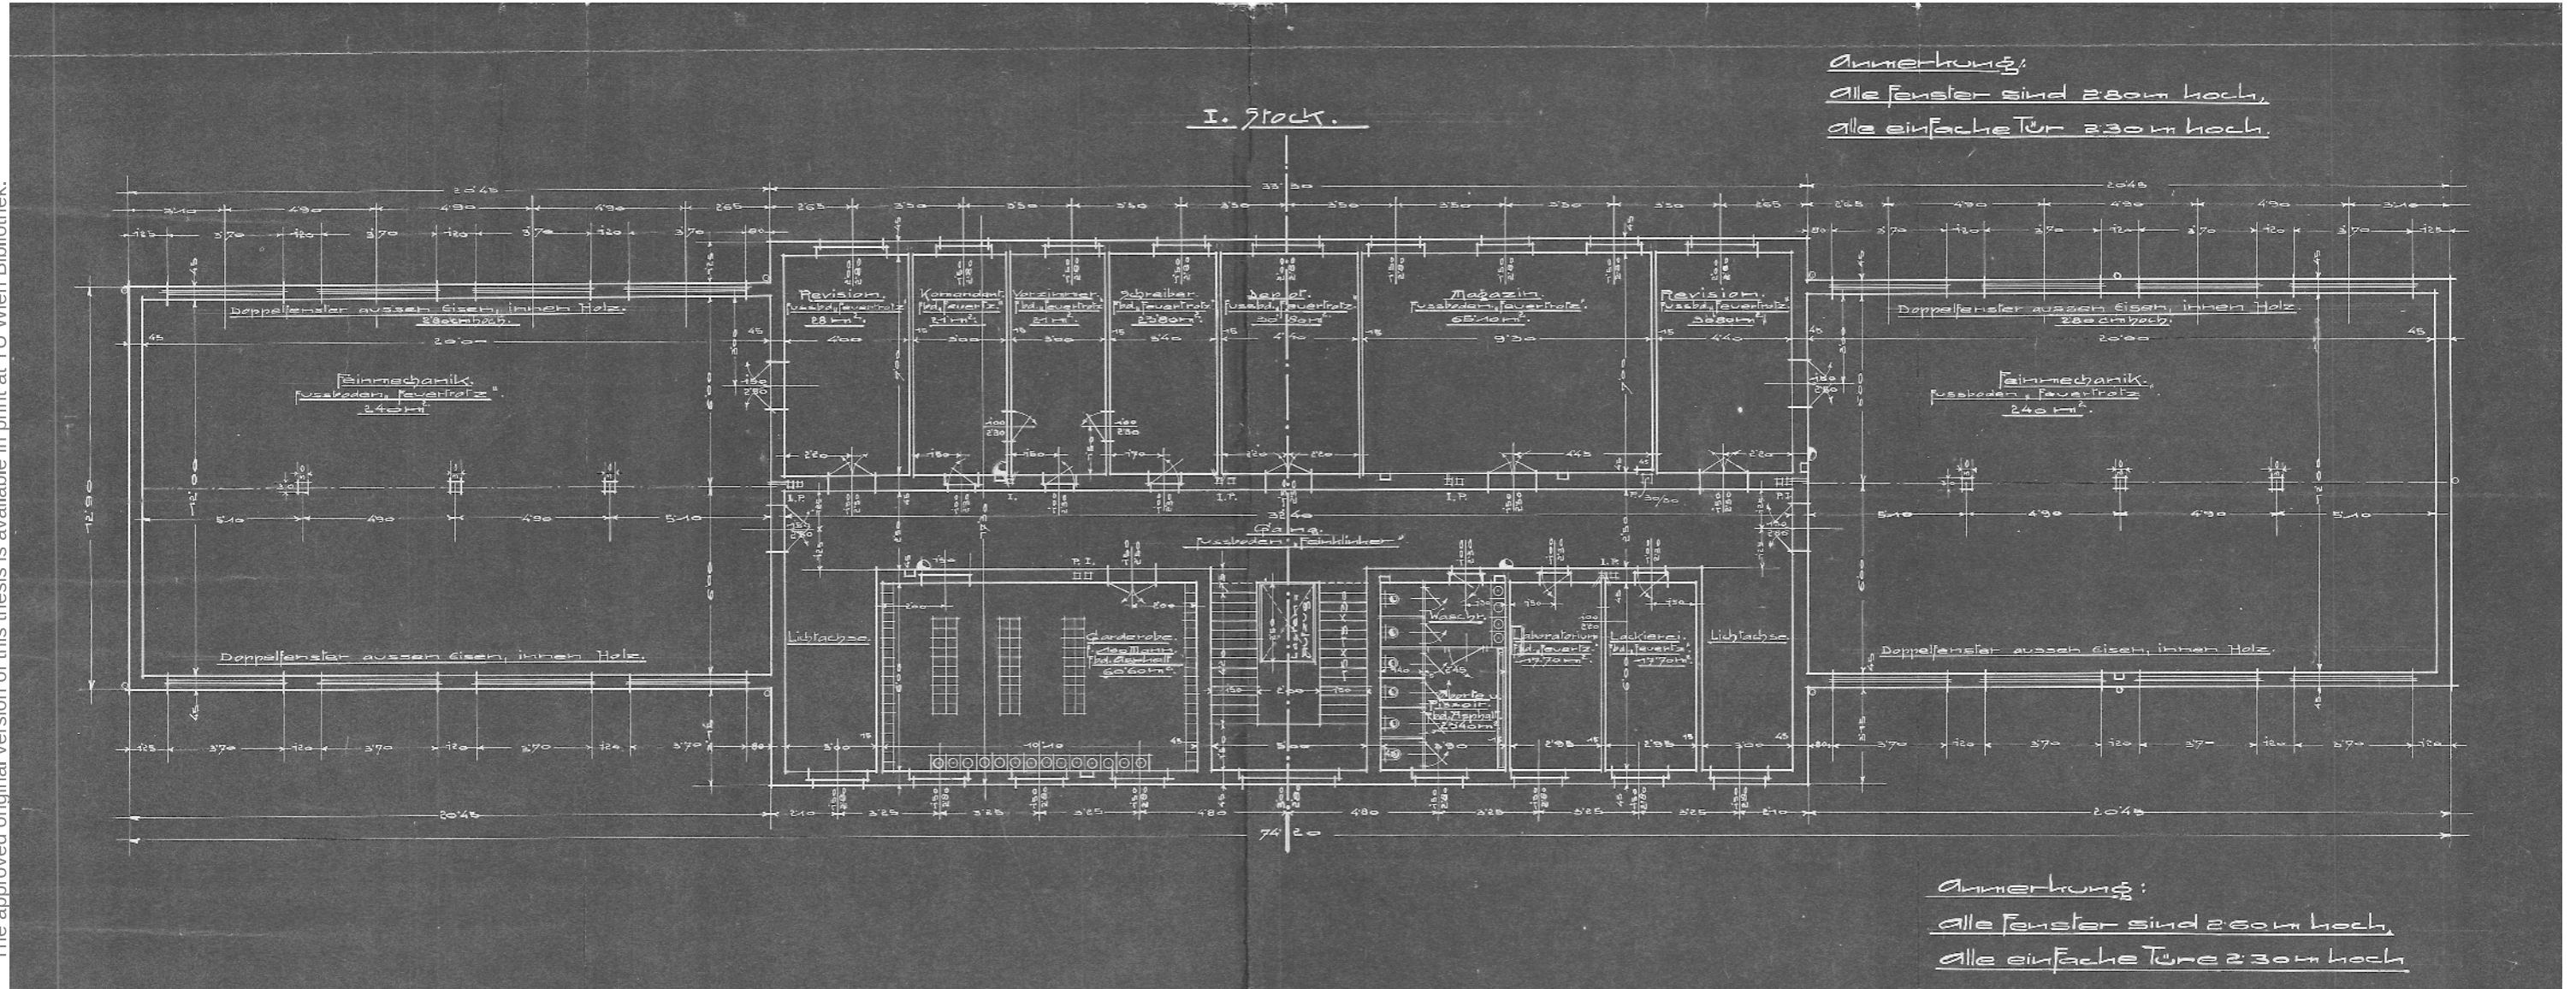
Originalplan Werksgebäude Nr. 210 Grundriss OG, Februar 1916
